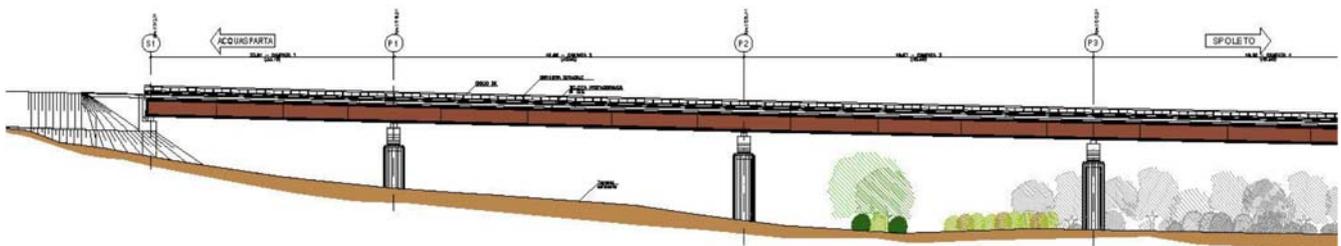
Prospetto del viadotto. Pile 1-2-3 con indicate le mitigazioni
